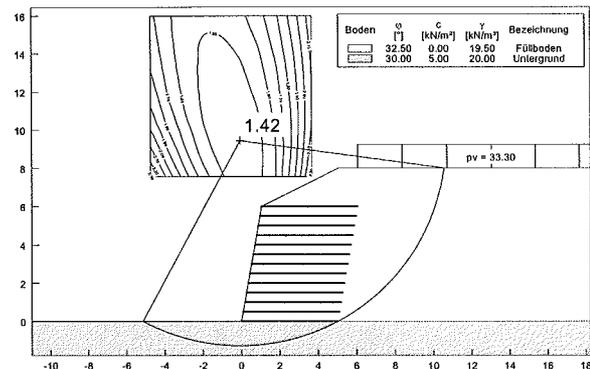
„Äußere“ Standsicherheit eines geokunststoffbewehrten (KBE) Bauwerks
